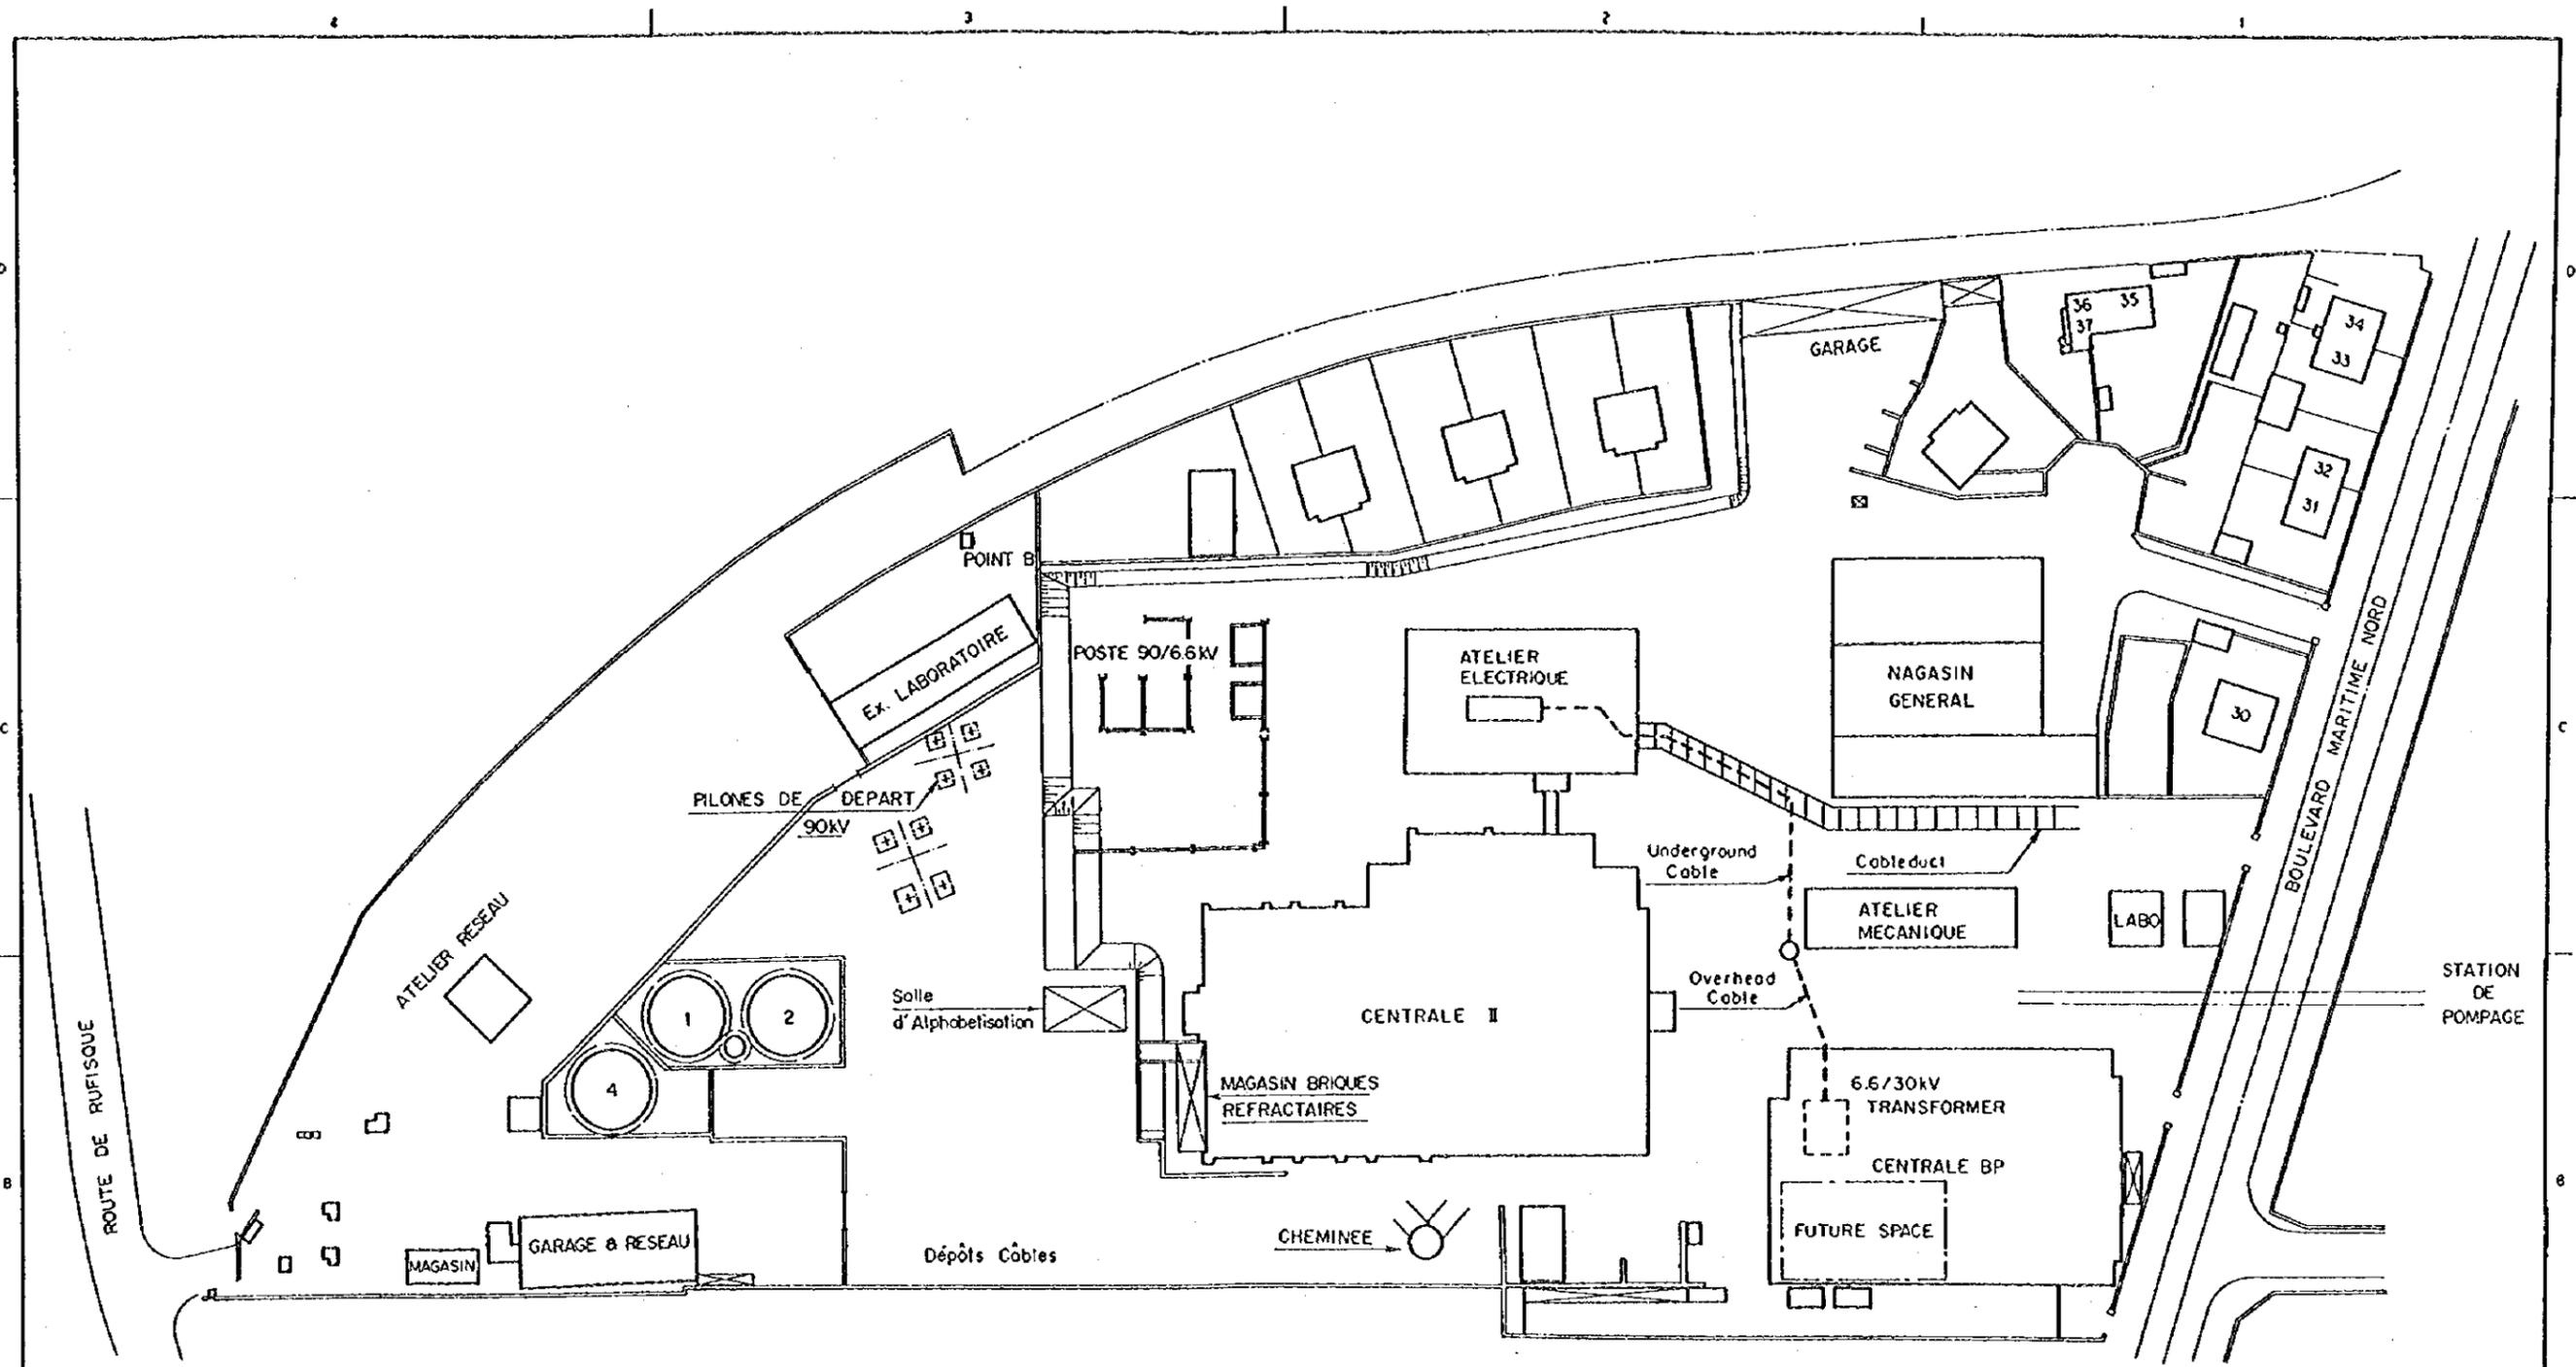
Plan général du site de la centrale Bel-Air
